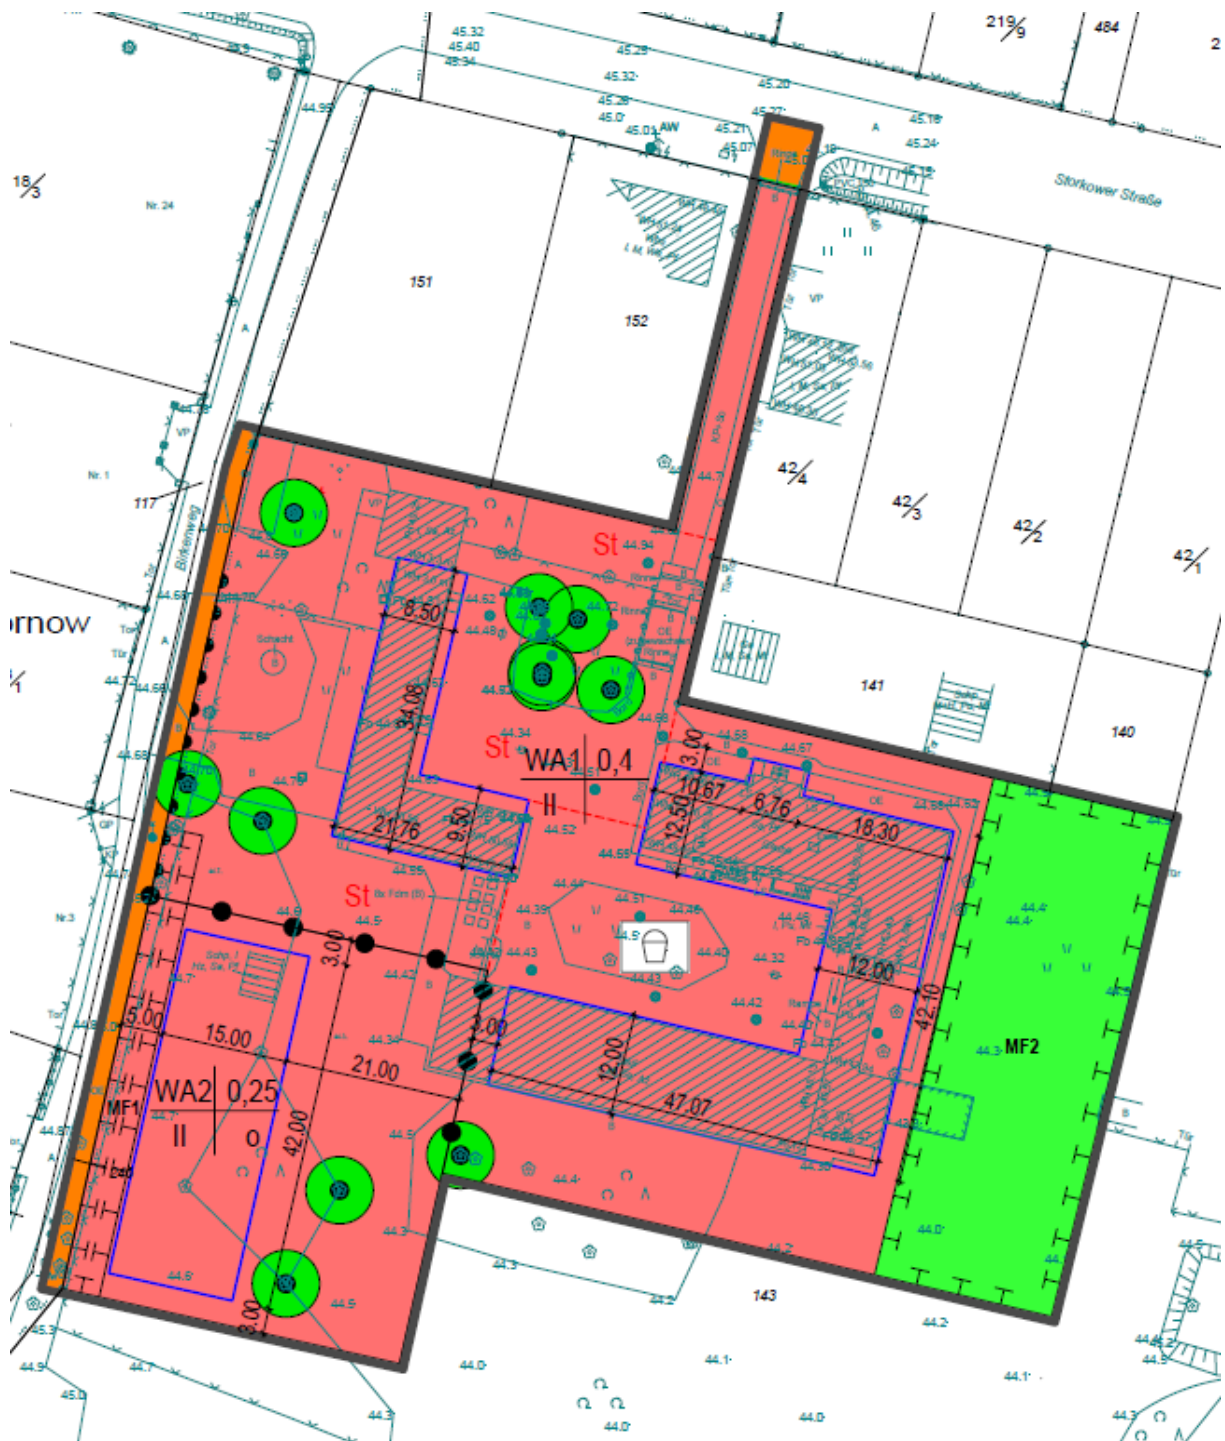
Bebauungsplan Nr. W18 Planzeichnung (Ausschnitt)
